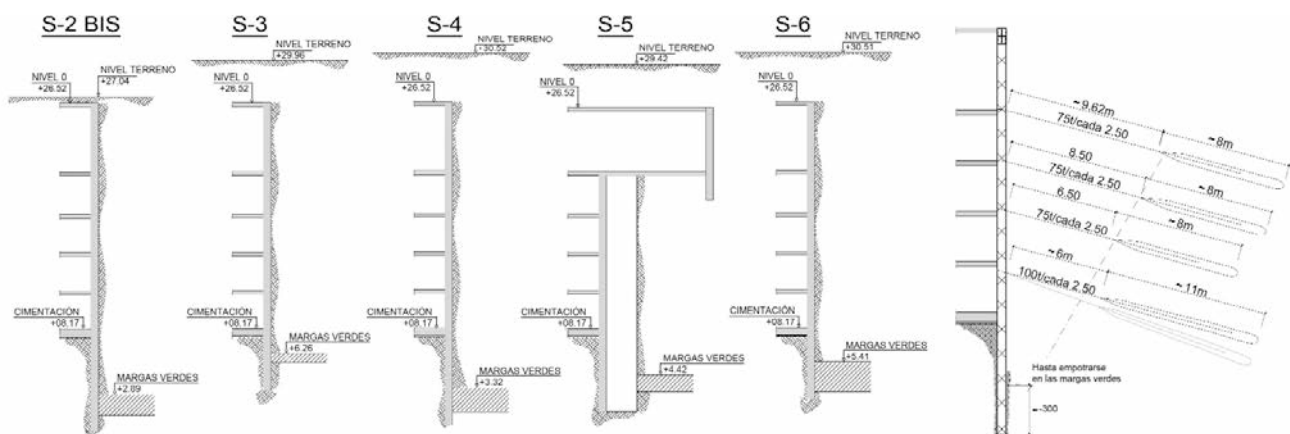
Secciones tipo de muro pantalla (acodaladas, con contrafuertes, ancladas)
